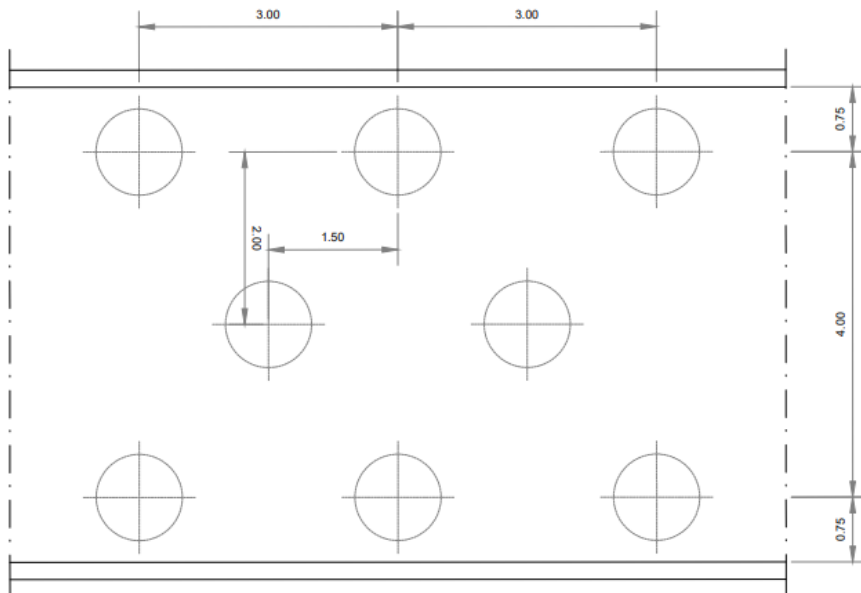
Pianta muro di sostegno su pali "Tipo 1".
